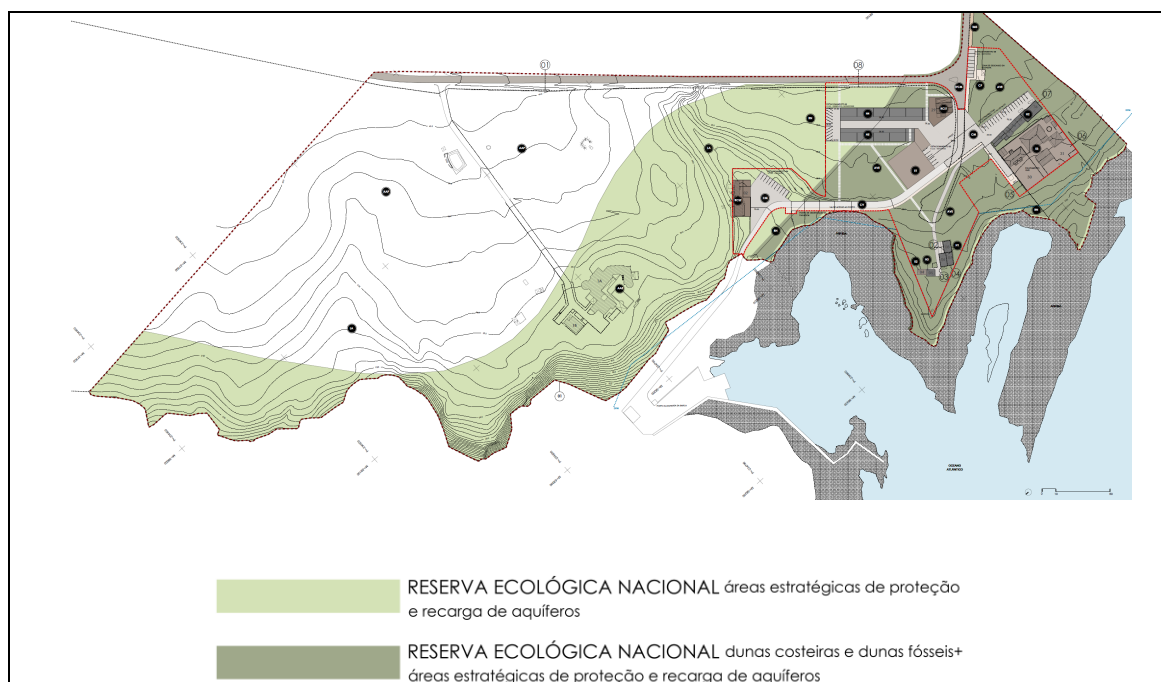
Planta de identificação das classes de REN na Ai do PIER da Entada da Barca – situação proposta de ocupação do PIER.
